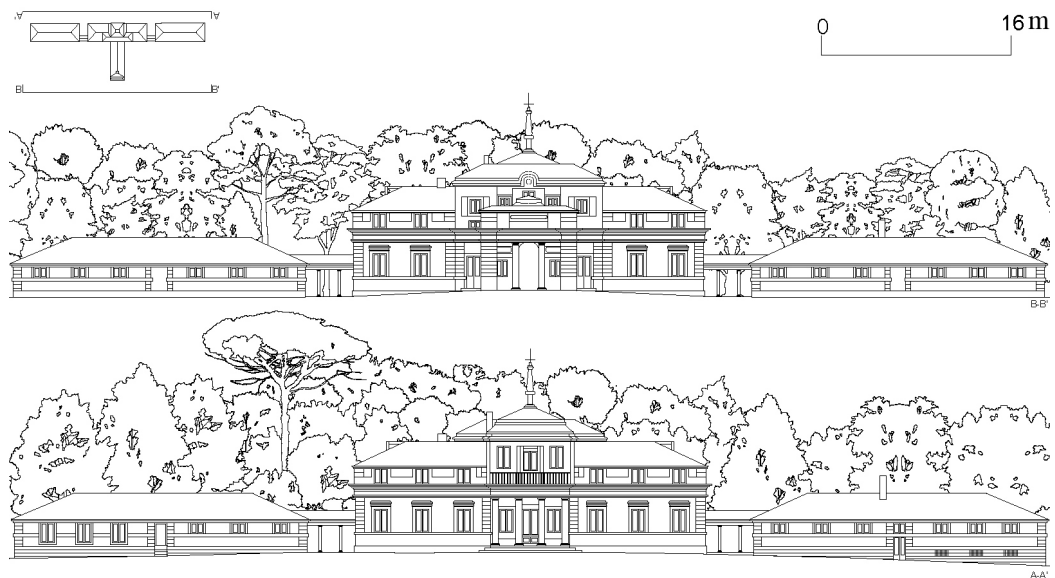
Il Jardines del Principe, prospetto Est (in basso) e prospetto Ovest (in alto). Elaborazione grafica degli autori.
